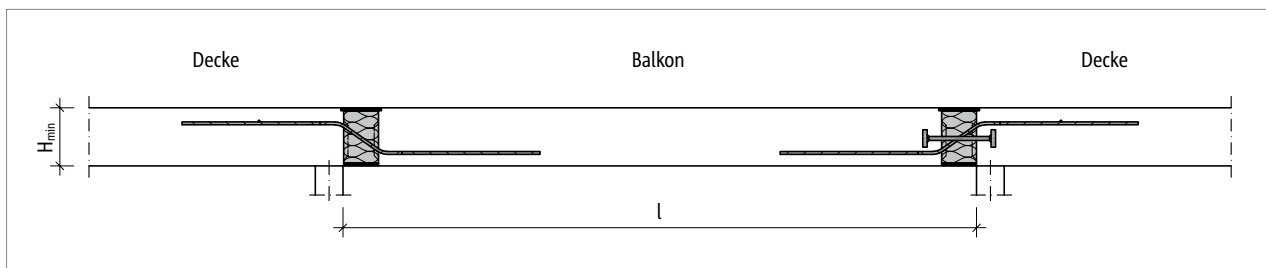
Schöck Isokorb® XT Typ QP-Z, QP: Statisches System
